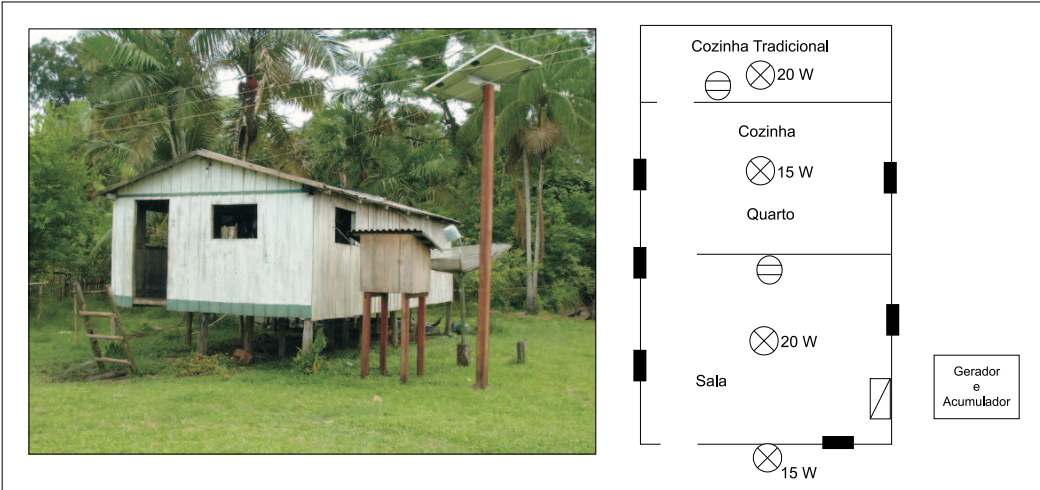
Vista externa do SFD6 e planta aproximada do domicílio.
